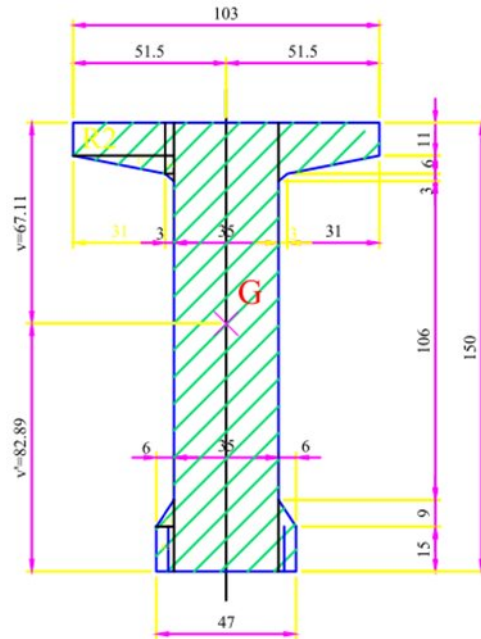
les dimensions de la section de la poutre à l'intermediaire
